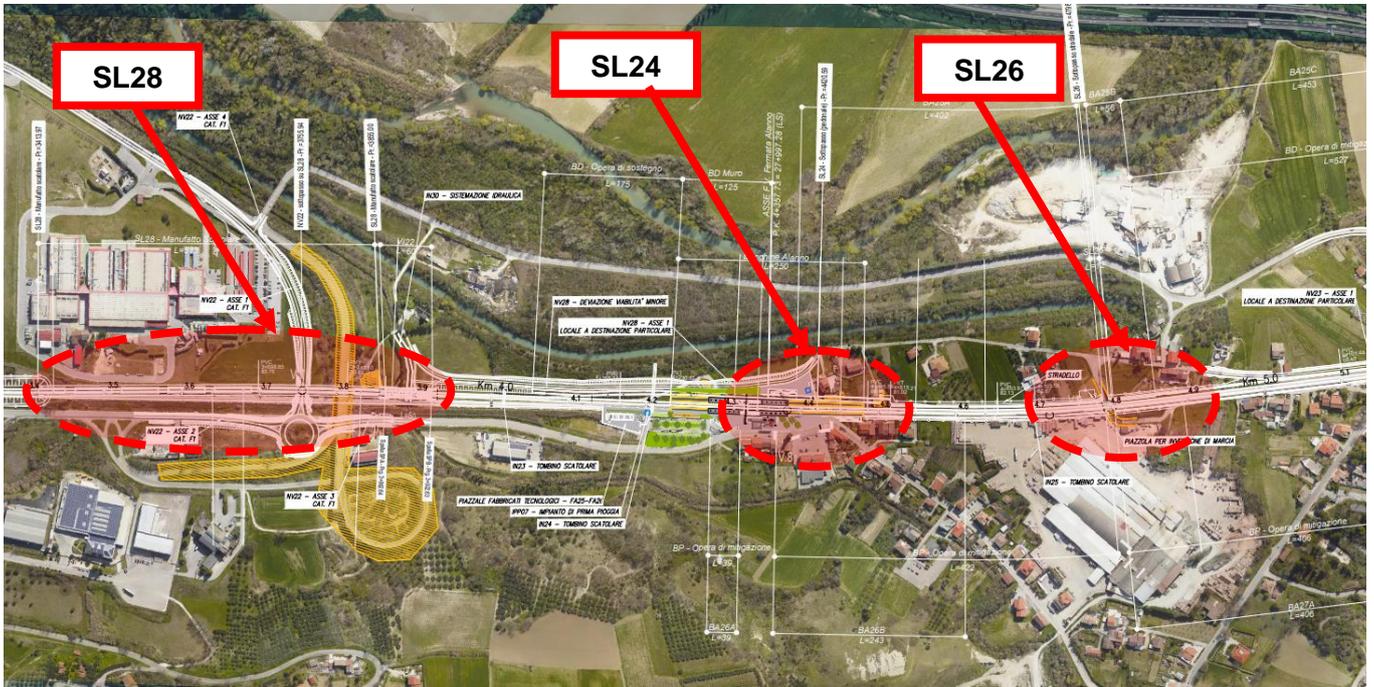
Inquadramento planimetrico sottopassi SL28 – SL24 – SL26
